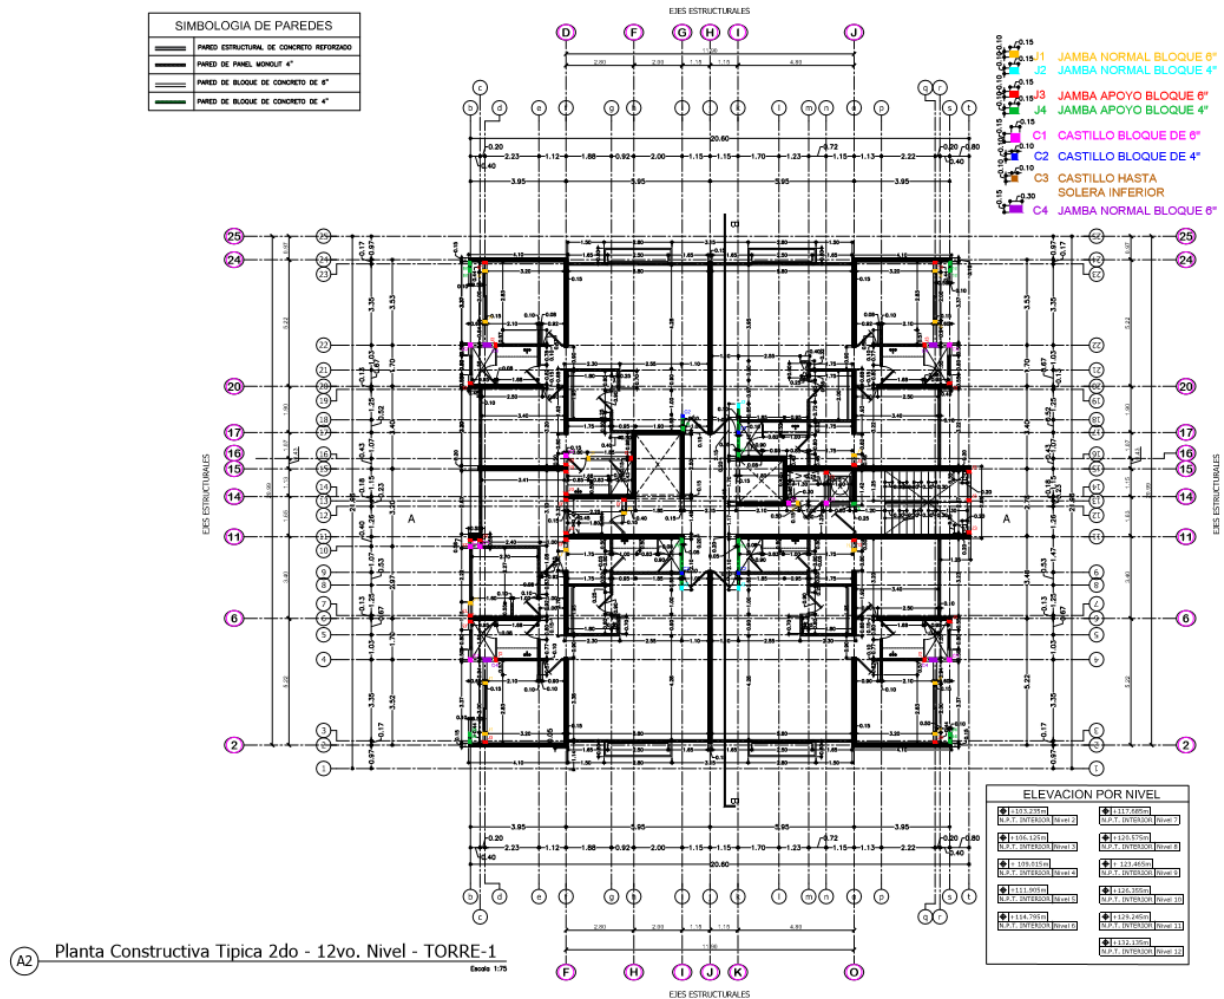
Plano constructivo previo a modificación de muros.
